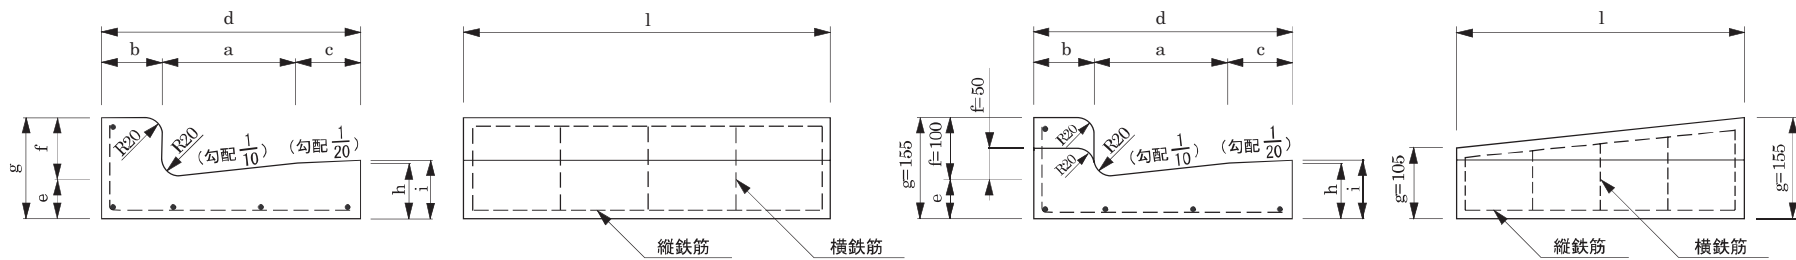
; コンクリートL形・鉄筋コンクリートL形
